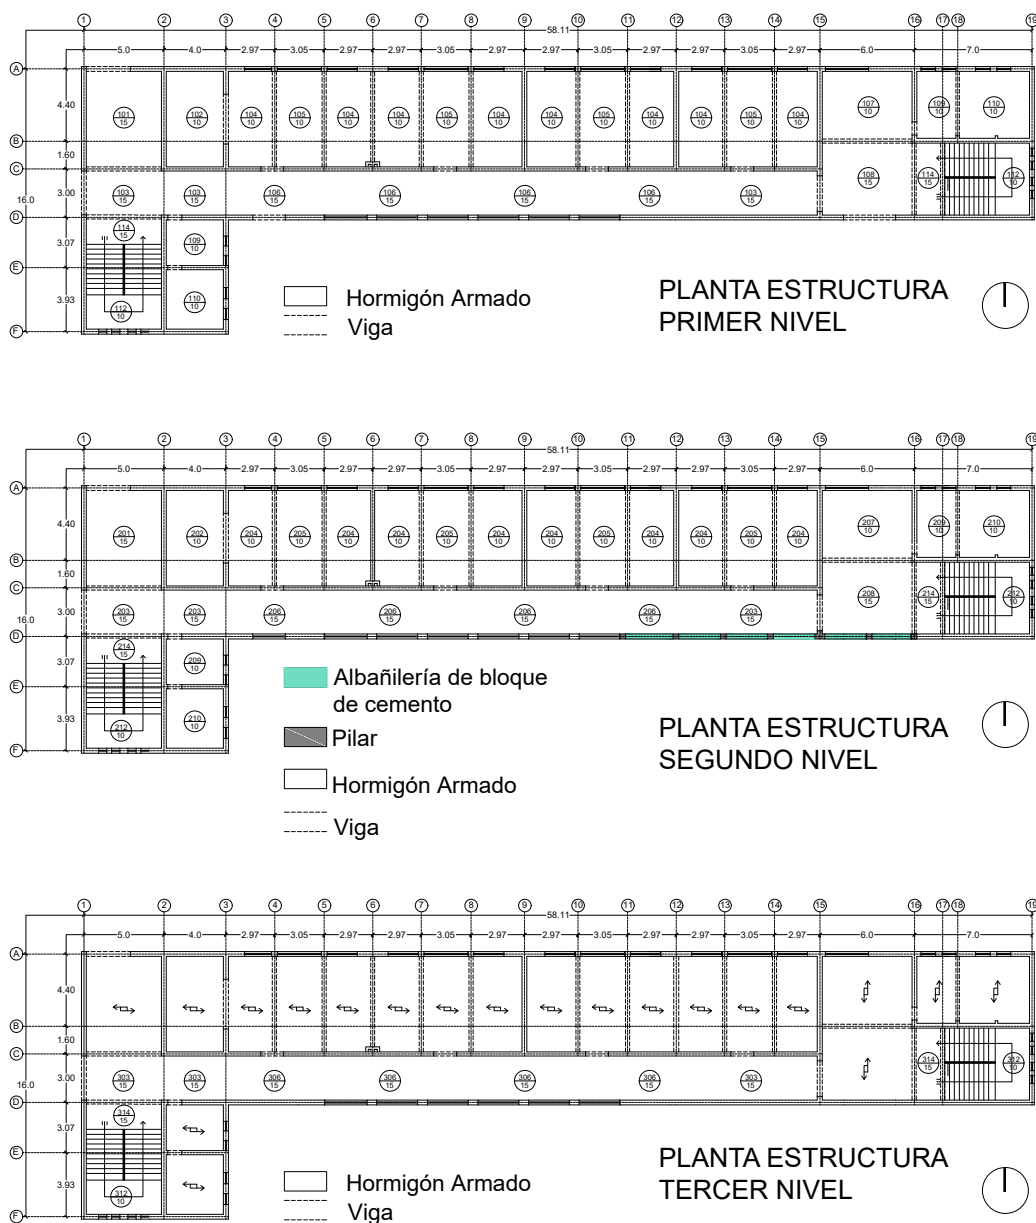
Plantas estructura Bloque F. Liceo de Niñas
